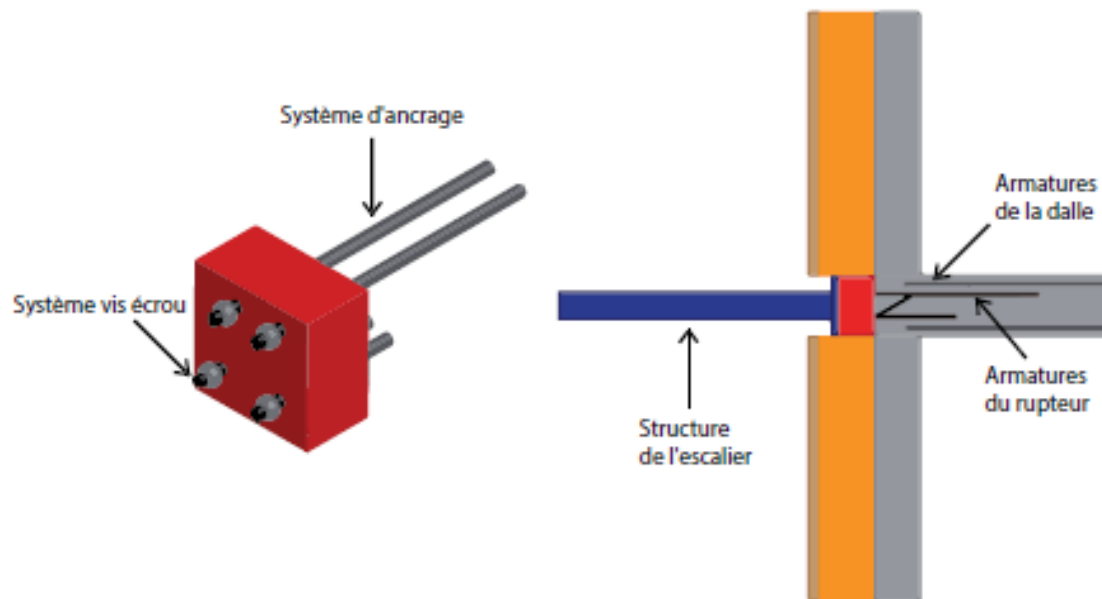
Système d'assemblage les escaliers à la dalle
